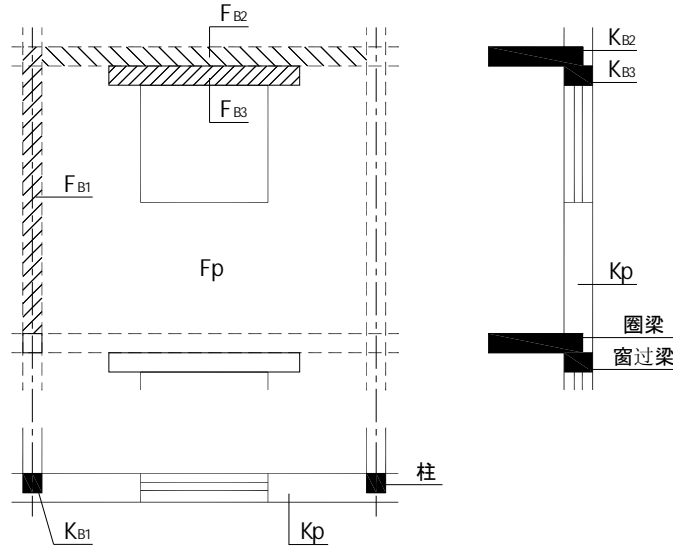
外壁主要部位と周囲熱橋部のイメージ図
